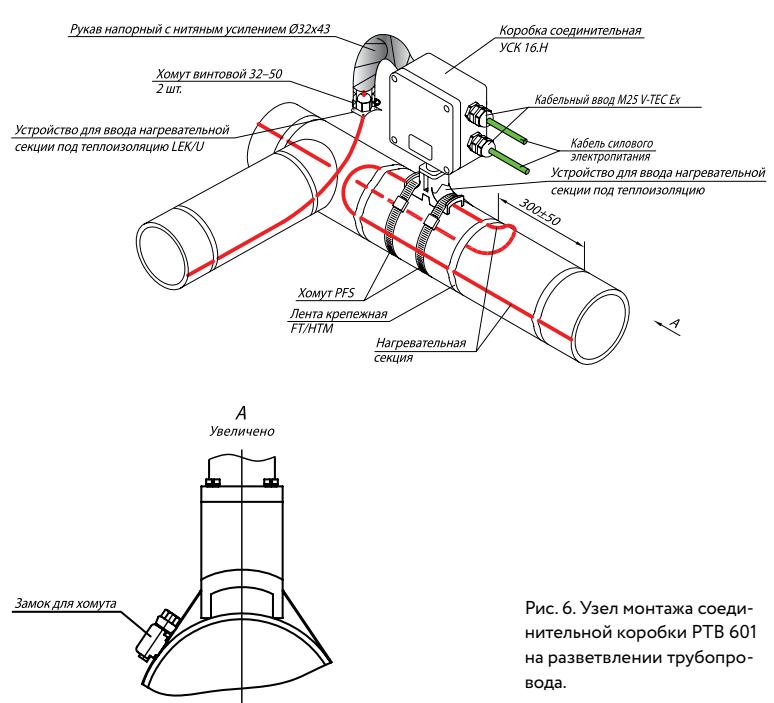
Узел монтажа соединительной коробки PTB 601 на разветвлении трубопровода.
